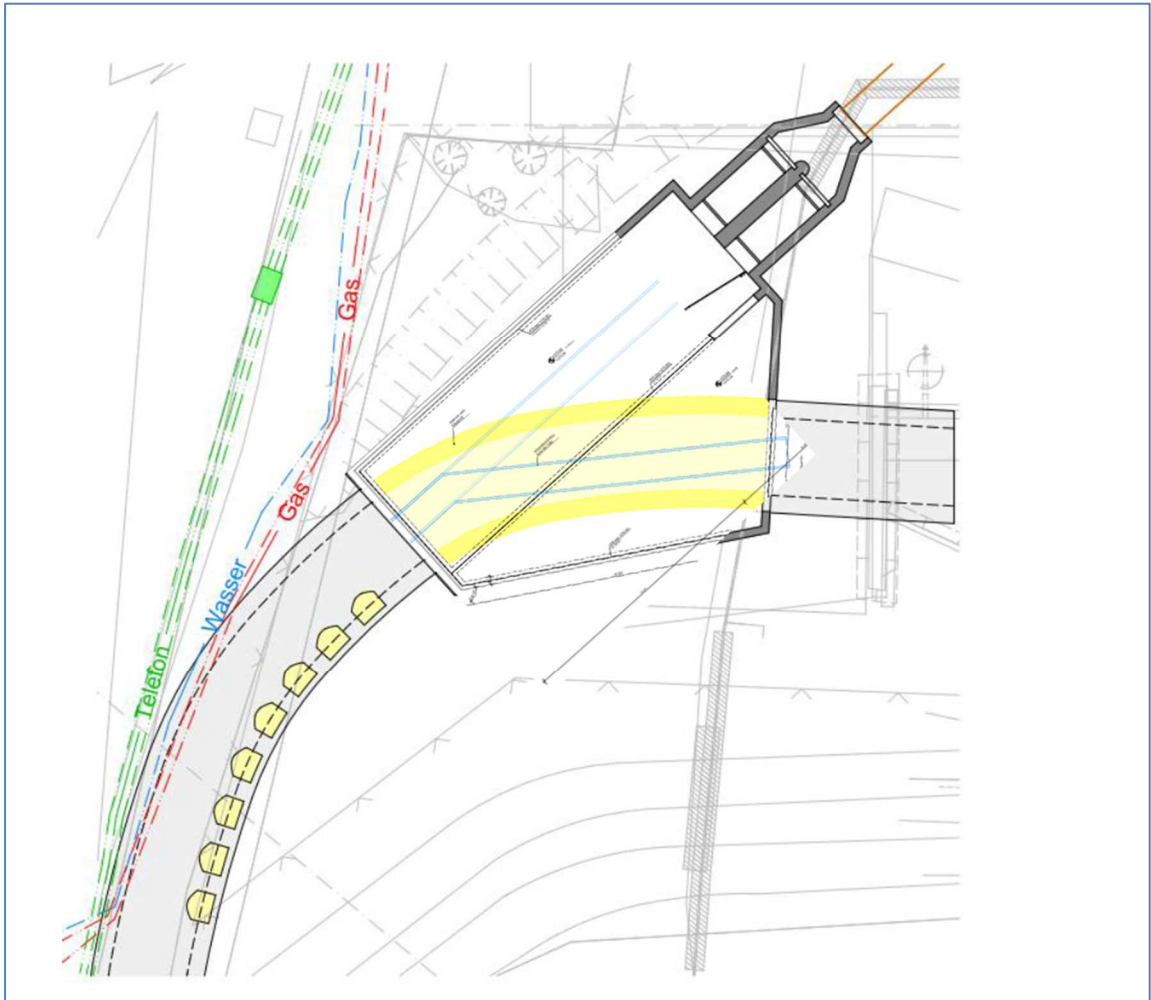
Lageplan Bauphase V (Herstellung Provisorischer Abschlag zum Bahrebach)
